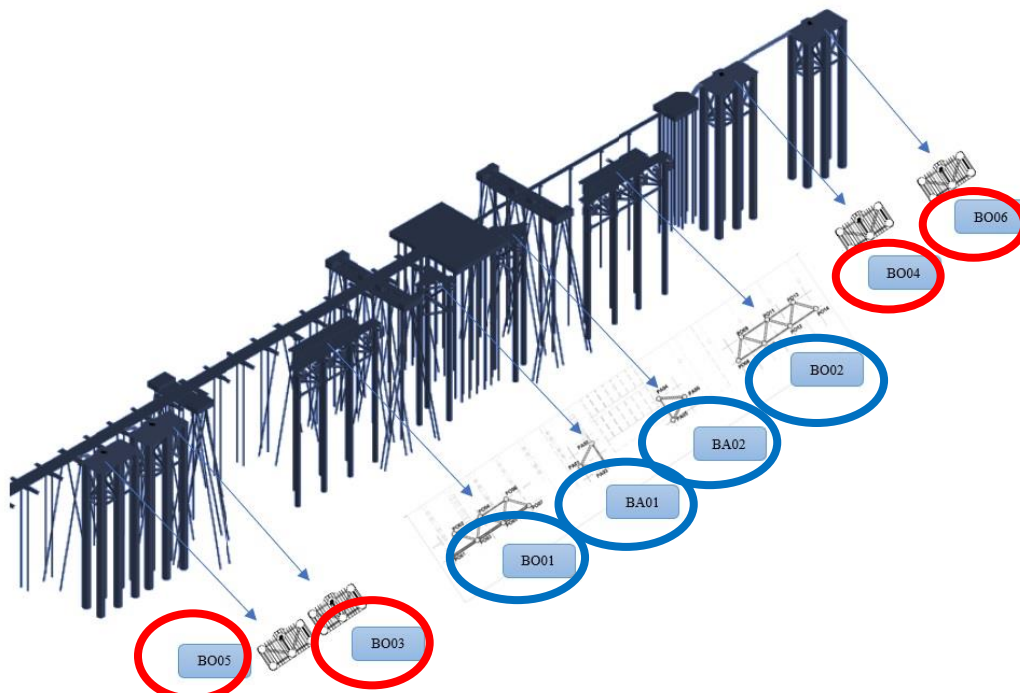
A - Configurazione futura del pontile: nel cerchio blu le bricole di accosto già autorizzate nell'ambito del progetto denominato "Vessel Reloading Panigaglia" approvato con parere n. 571 del 10 ottobre 2022; nel cerchio rosso le bricole oggetto del presente progetto di ammodernamento e adeguamento dell'impianto GNL di Panigaglia
